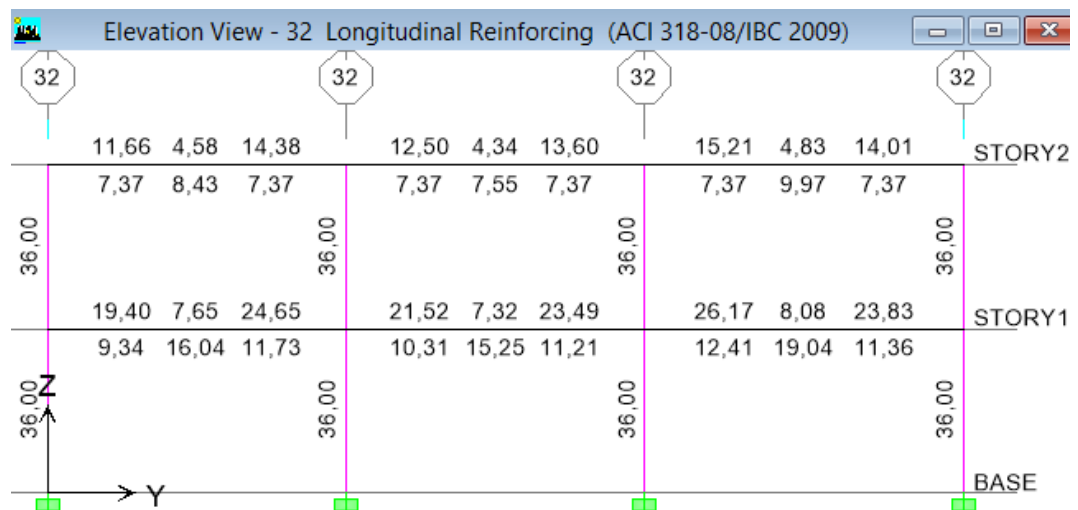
Acero en Vigas y Columnas en el Pórtico 32 – C. Quirúrgico- (CEC2002)
